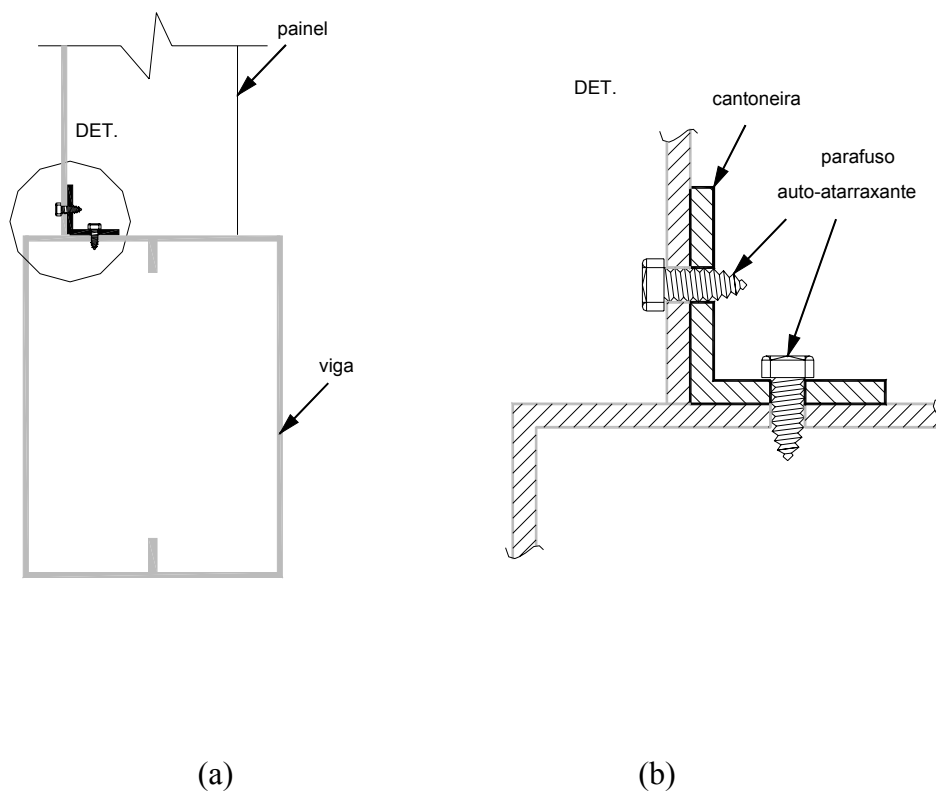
Esquema de ligação parafusada entre a viga e o painel: (a) corte do painel e da viga, com o sistema de ligação; (b) detalhe de ligação utilizando cantoneira e parafusos auto-atarraxantes.
